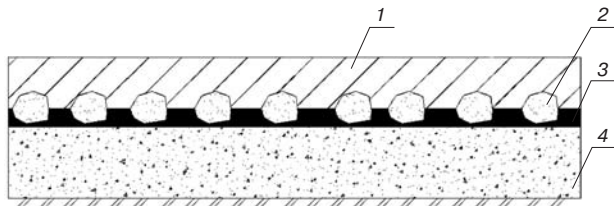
Конструкция тонкослойного асфальтобетонного покрытия на старом цементобетонном основании в Республике Беларусь: 1 – асфальтобетон 2,5–3 см; 2 – щебень фракции 10–15 мм; 3 – битумно-полимерное вяжущее; 4 – старое цементобетонное покрытие
